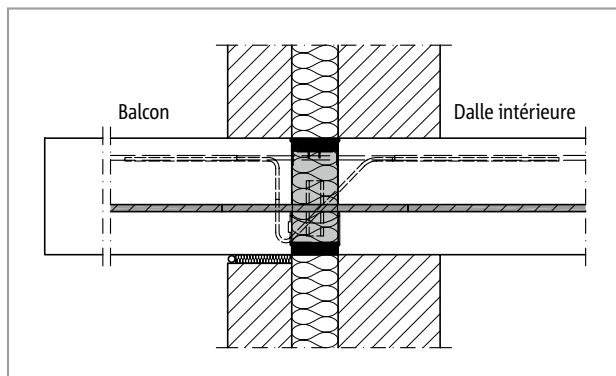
Schöck Isokorb® T Type CK, CH-NN : raccord avec maçonnerie pleine
